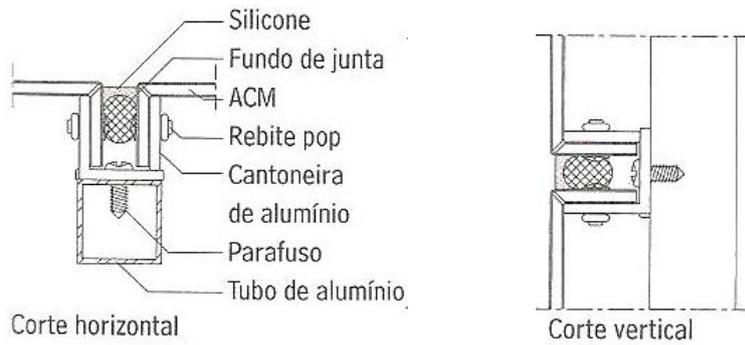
Sistema parafusado – junta selada com silicone (Fonte: Pini, 2008)
